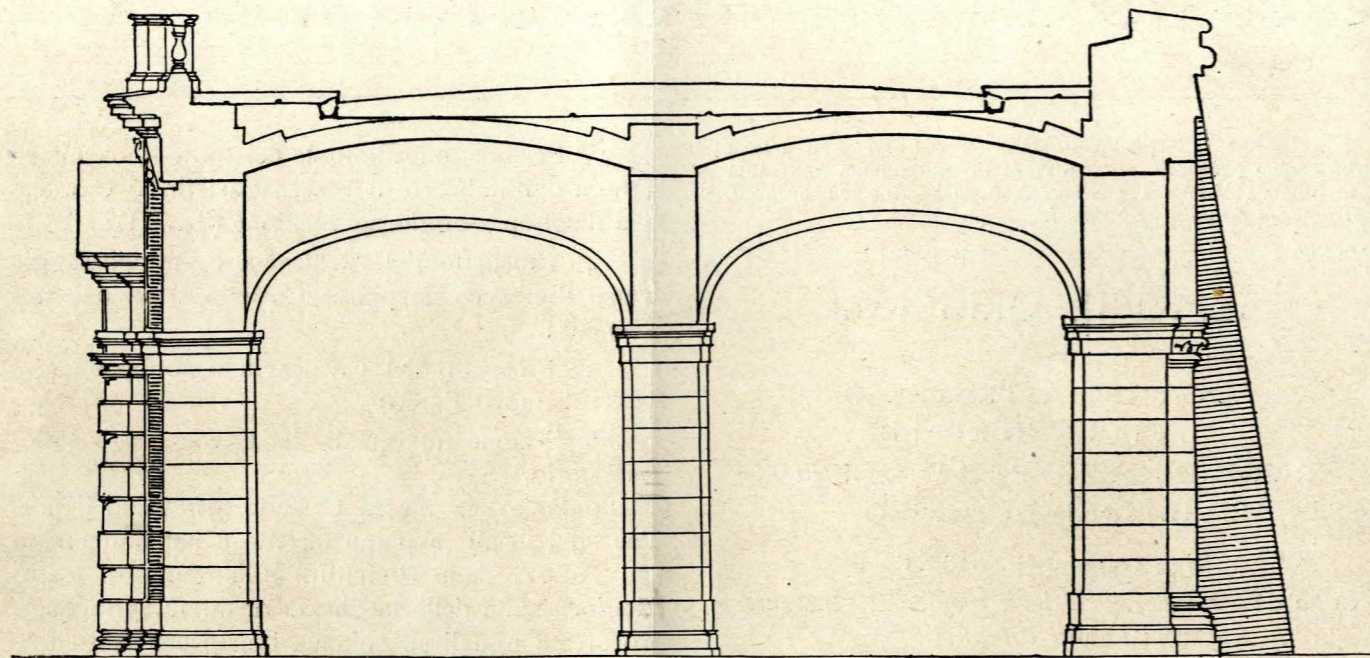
SEZIONE TRASVERSALE DEL CAVALCAVIA O SOTTOPASSAGGIO.
